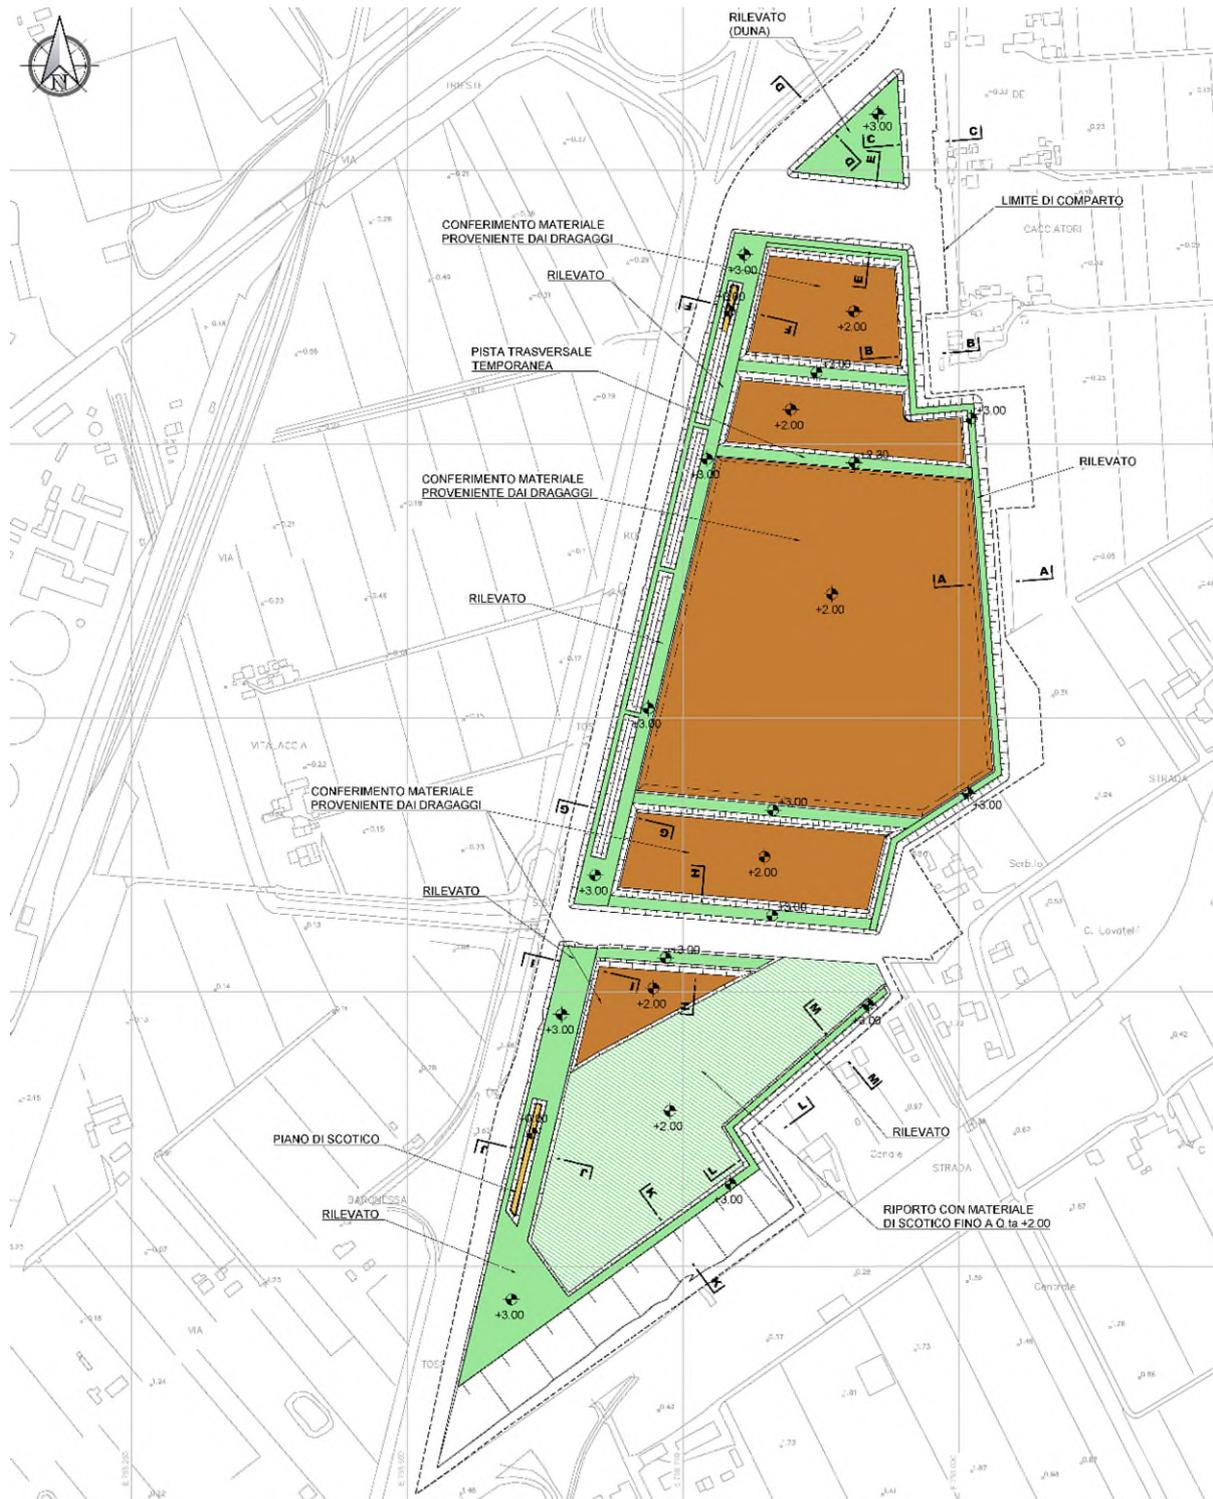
Area Logistica L2 – Planimetria di progetto presente stralcio (Stralcio IV)
